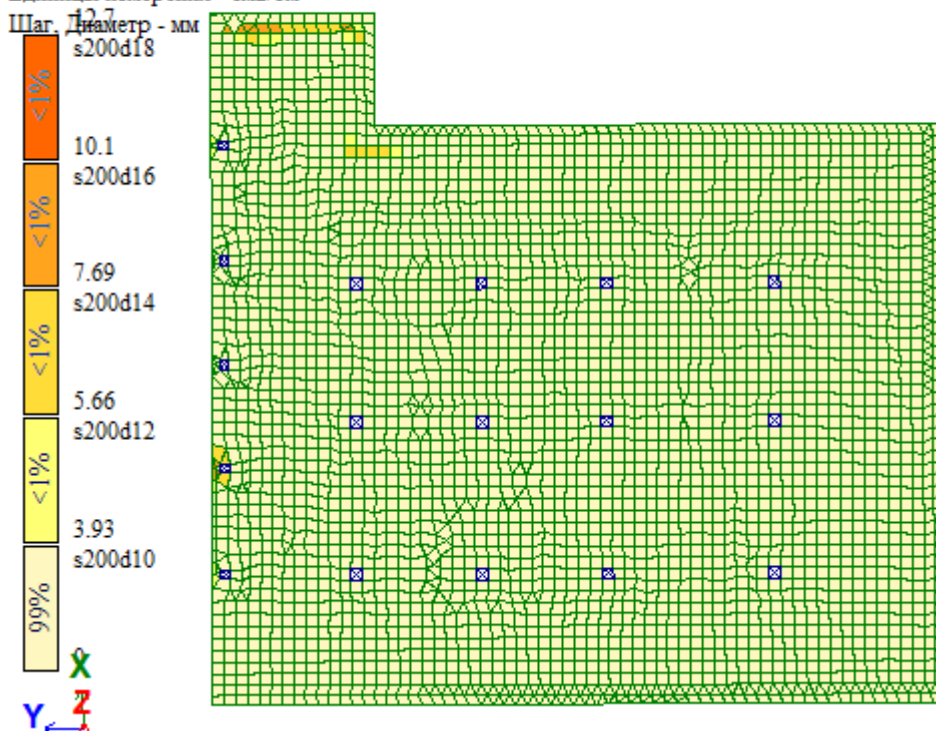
Схема армирования низа плит по оси ОХ
